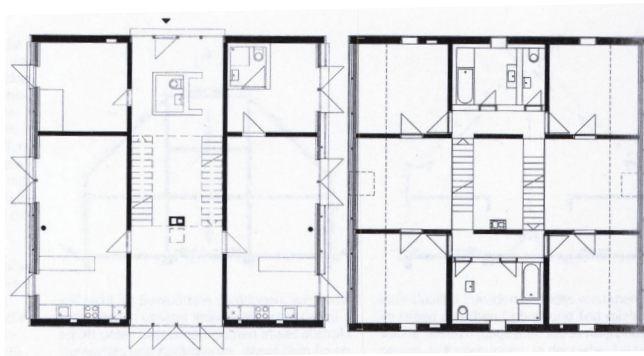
Grundriss Mehrfamilienhaus
